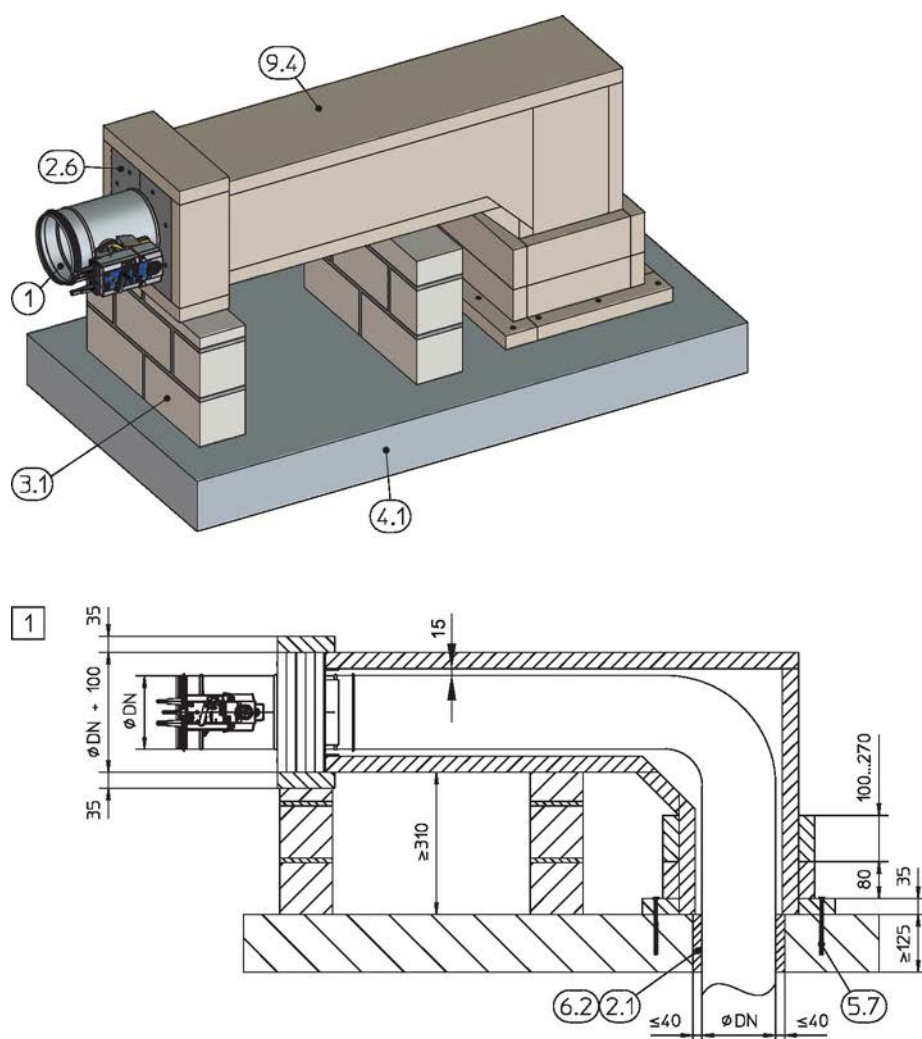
Монтаж без применения строительного раствора с монтажным комплектом WE / WE2 на удалении от сплошных перекрытий
